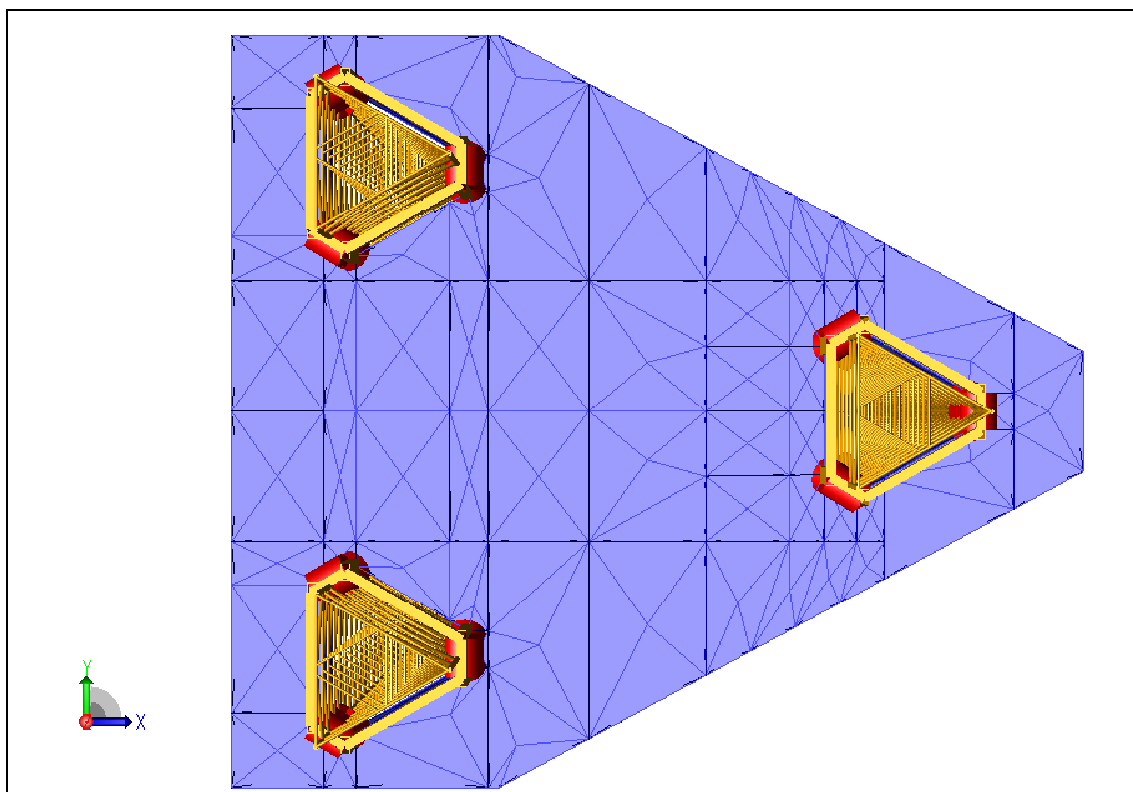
Posicionamento em planta do sistema de elevação da plataforma
